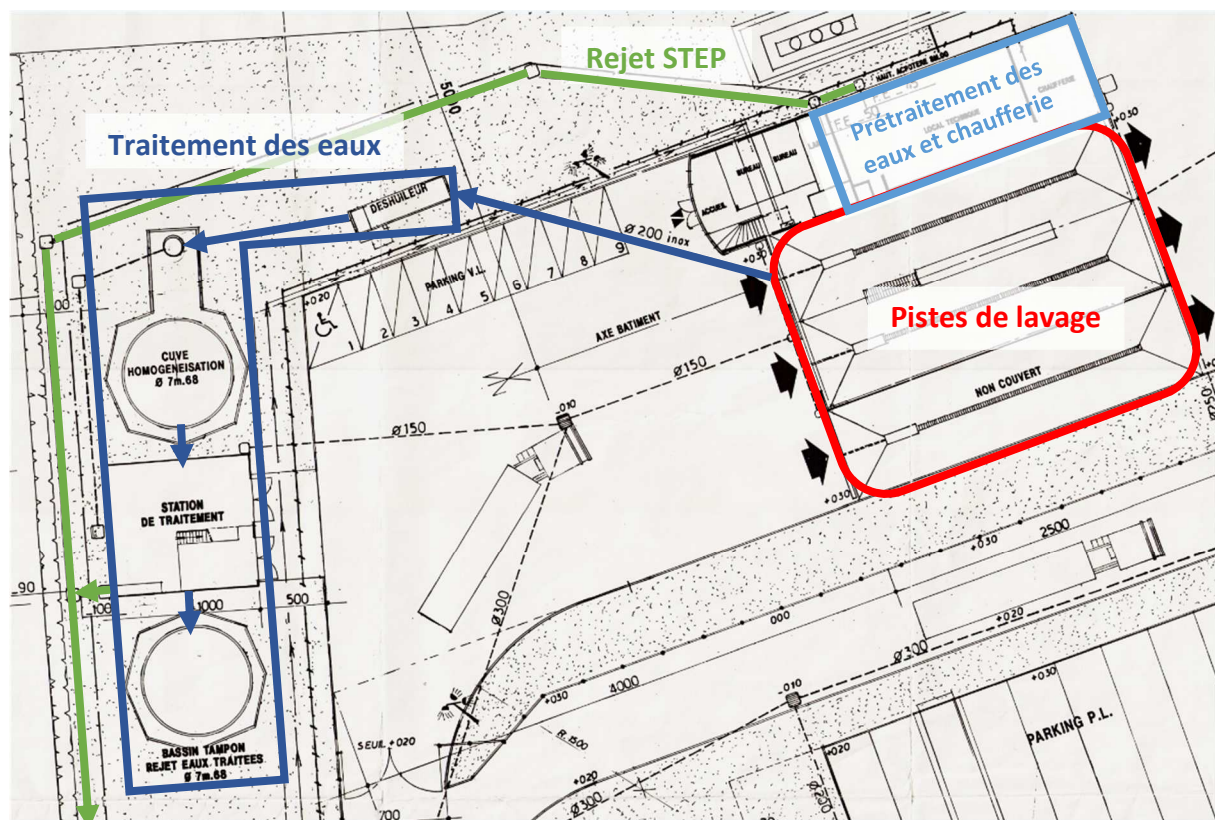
Plan d'ensemble du site XPO Tank Cleaning de Damparis
